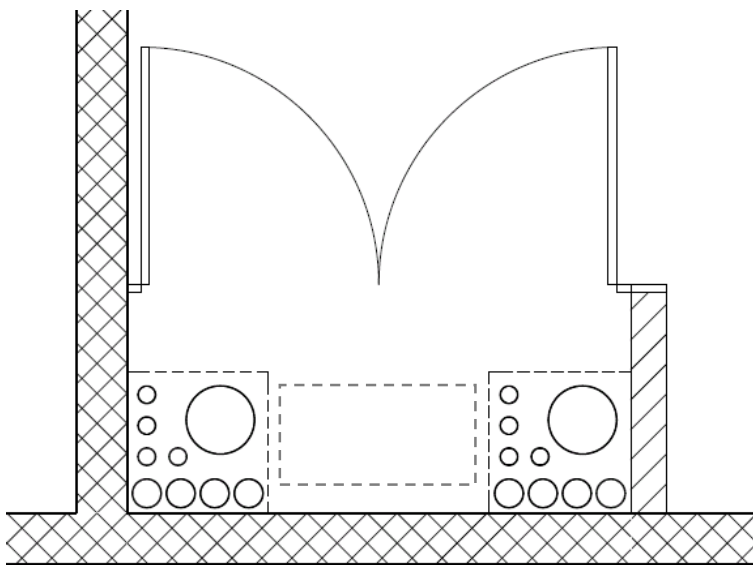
Grundriss Steigzone mit Aussparungen
